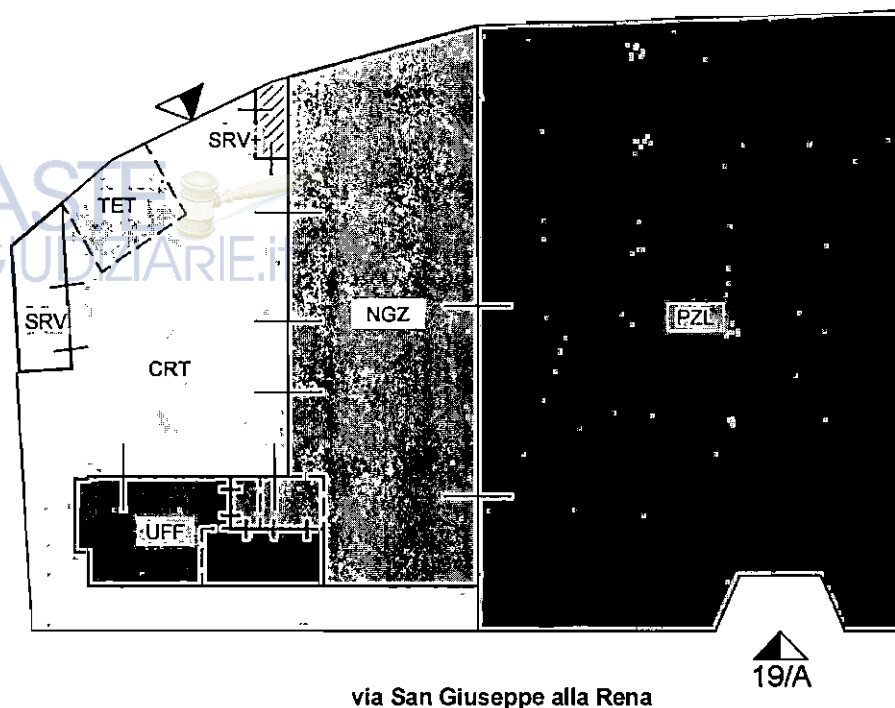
/2 - la distribuzione in pianta al p.T. dell'asset edilizio n.02
